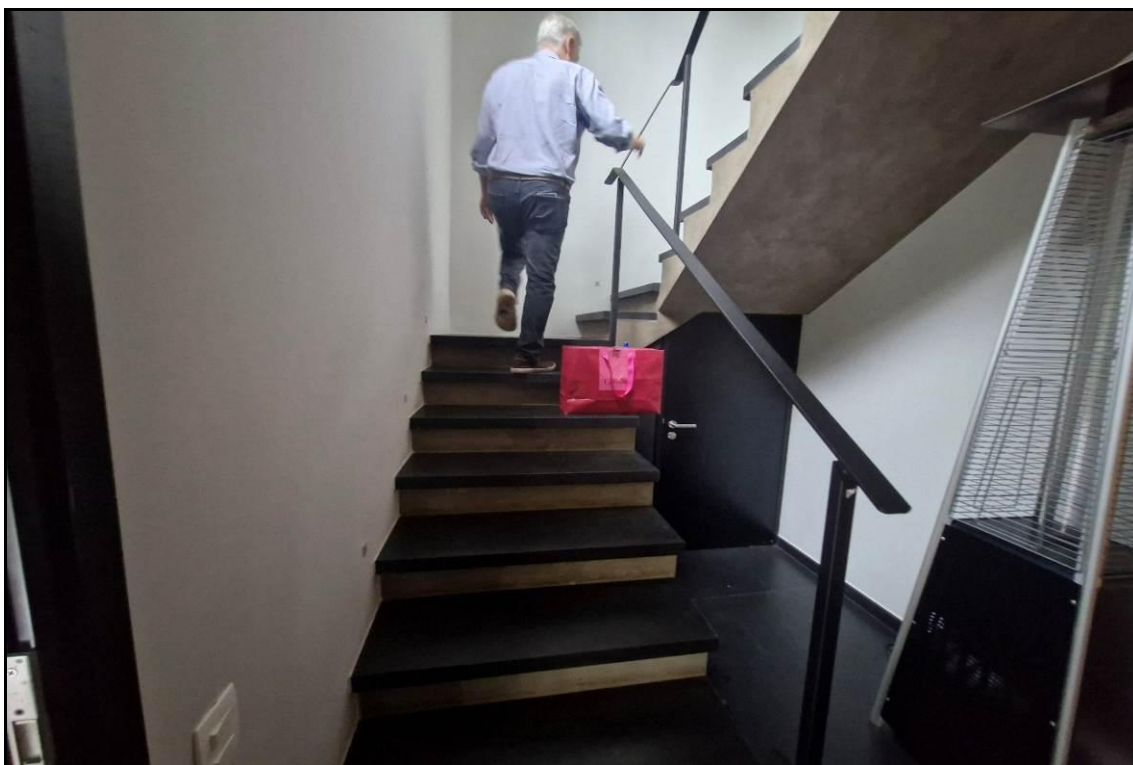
Escadaria de acesso ao pavimento superior da edícula.
